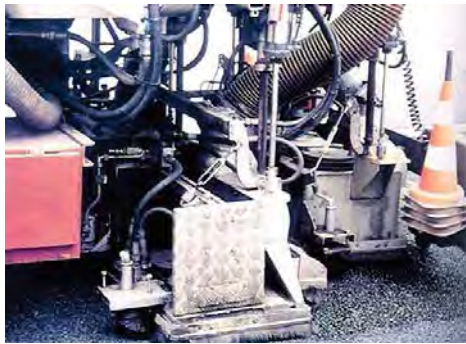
MÁQUINA PARA DESAZOLVAR
